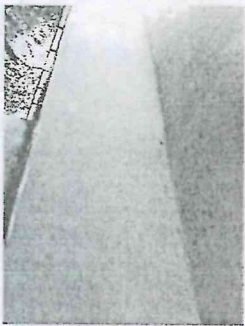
Grieta vertical entre el muro del elevador y la estructura del edificio.
